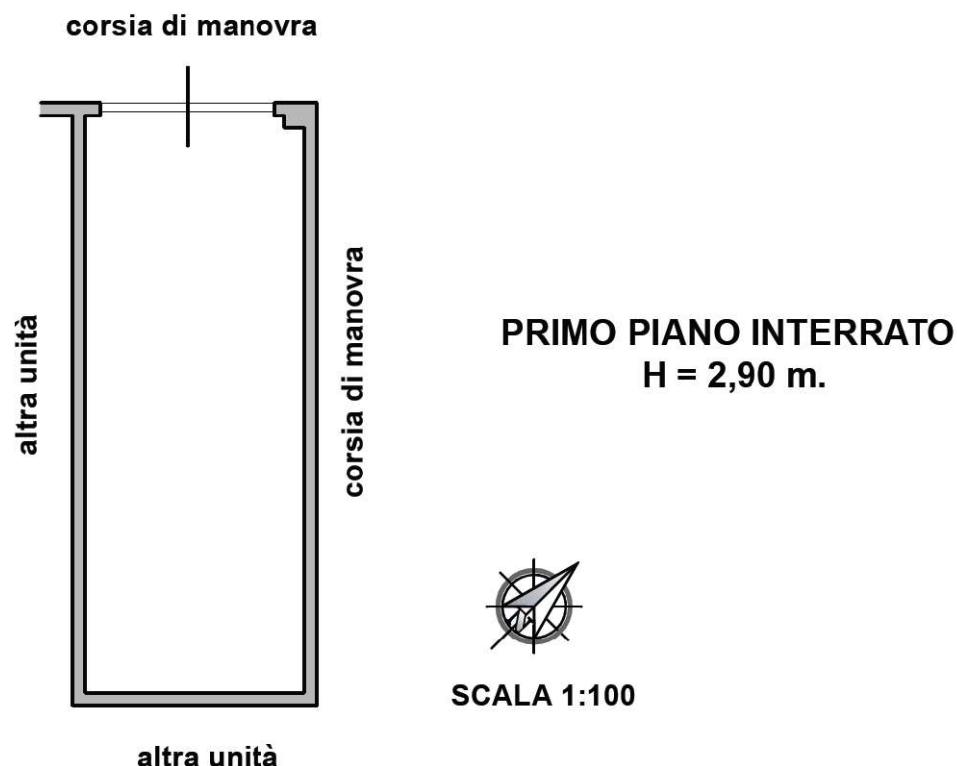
LOTTO 23 – Planimetria box auto foglio 76 – part. 620 – sub. 218
